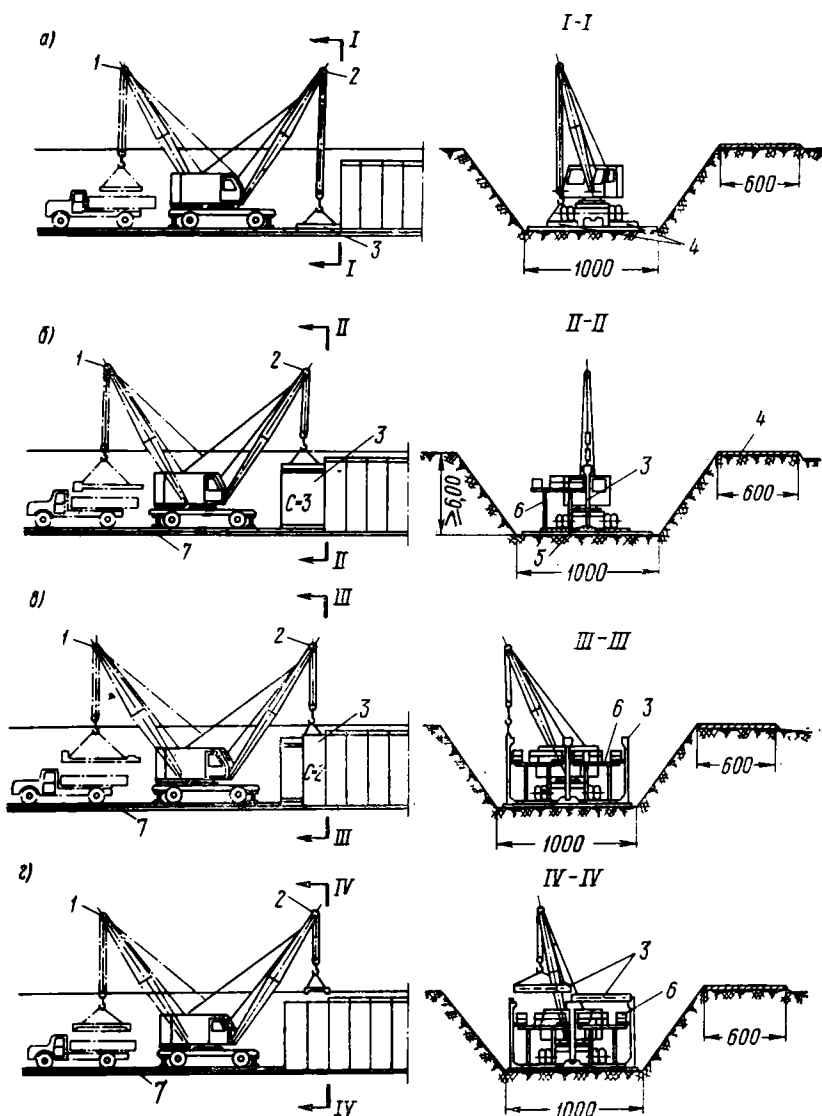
Схема сооружения сборных железобетонных конструкций:
